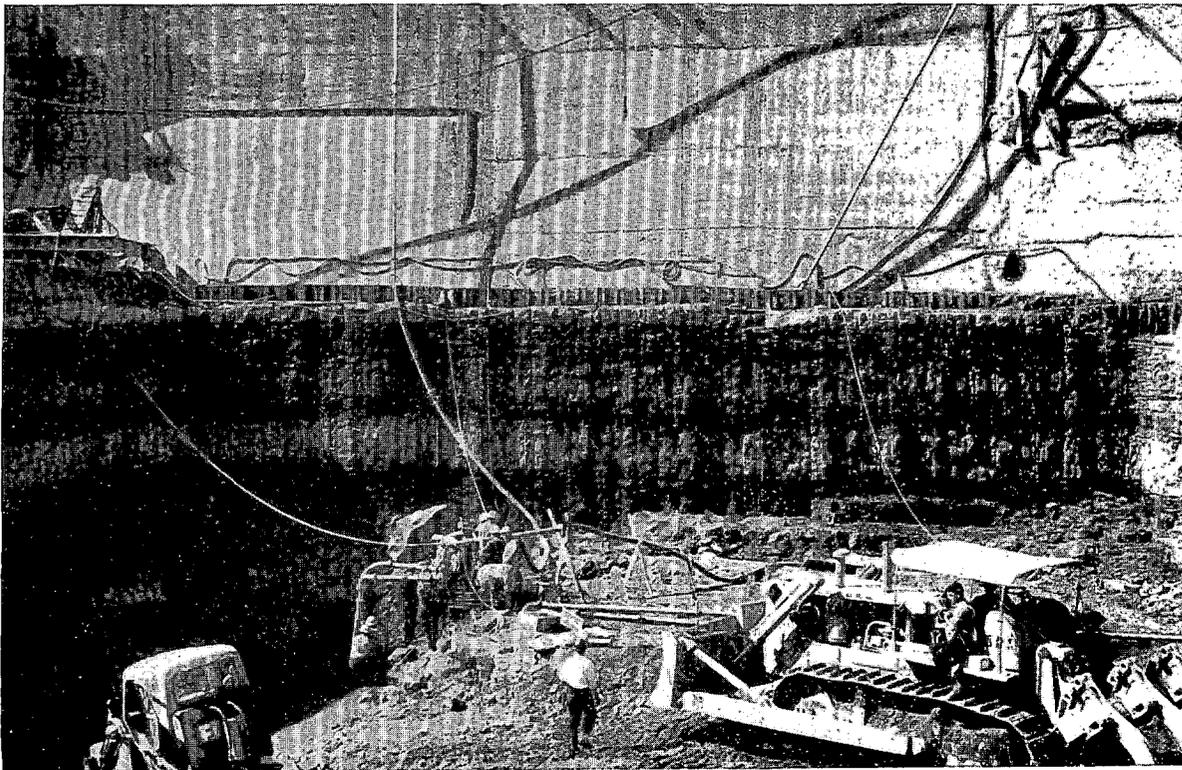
^a—Presa de Mequinzena. Excavaciones para el refuerzo realizadas con precorte.
